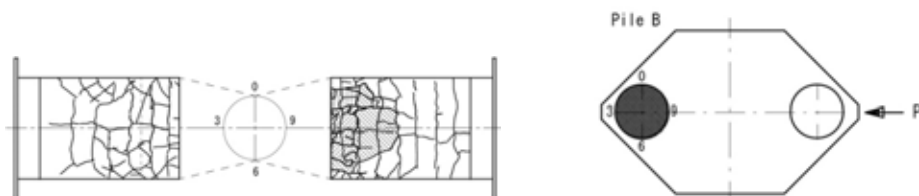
杭体の最終ひび割れ状況図 (Case CPP-C-2, Pile B)
